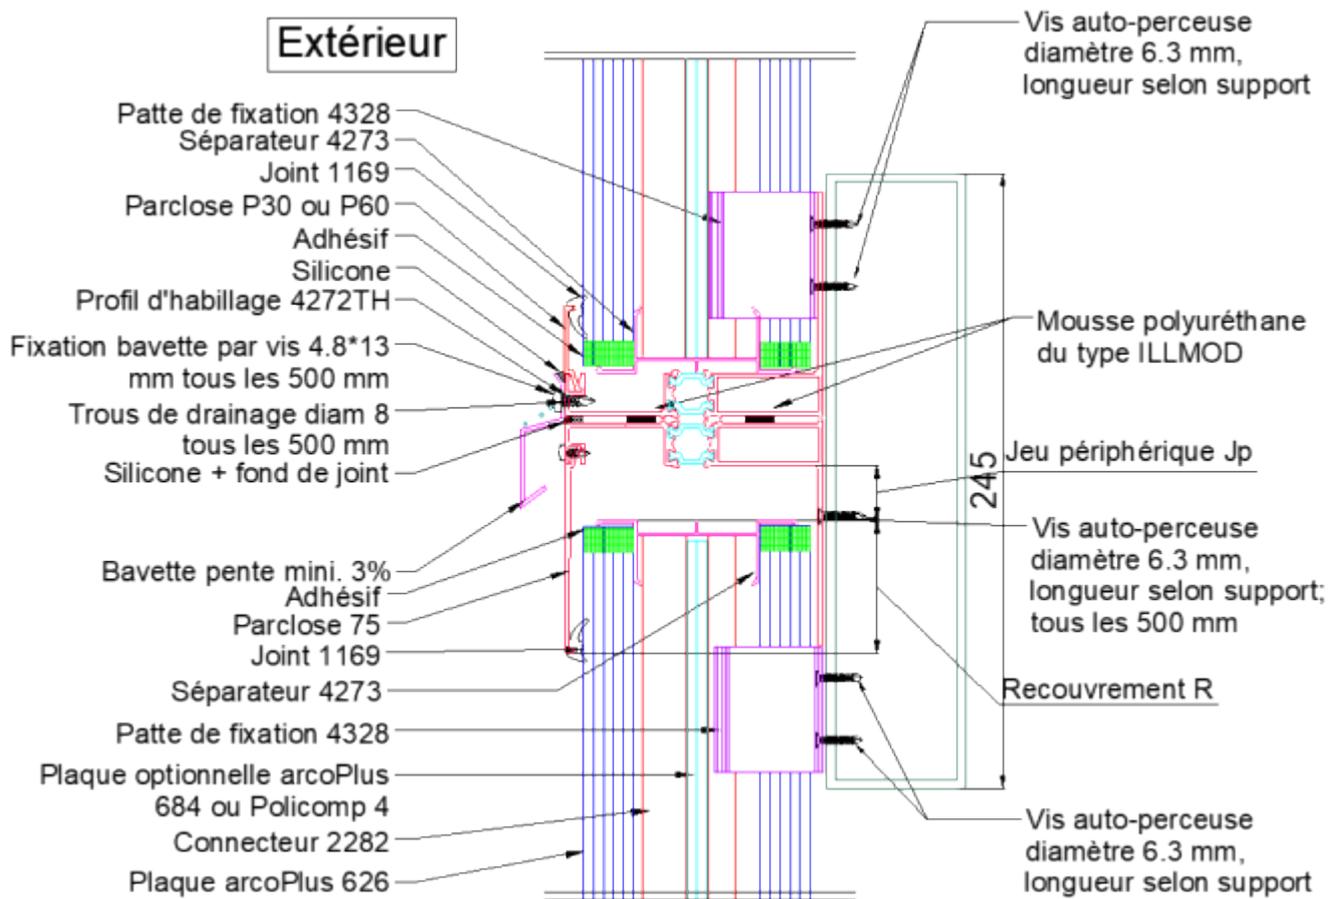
Raccord de hauteur n°1 - façade basse limitée à 6 mètres de haut
